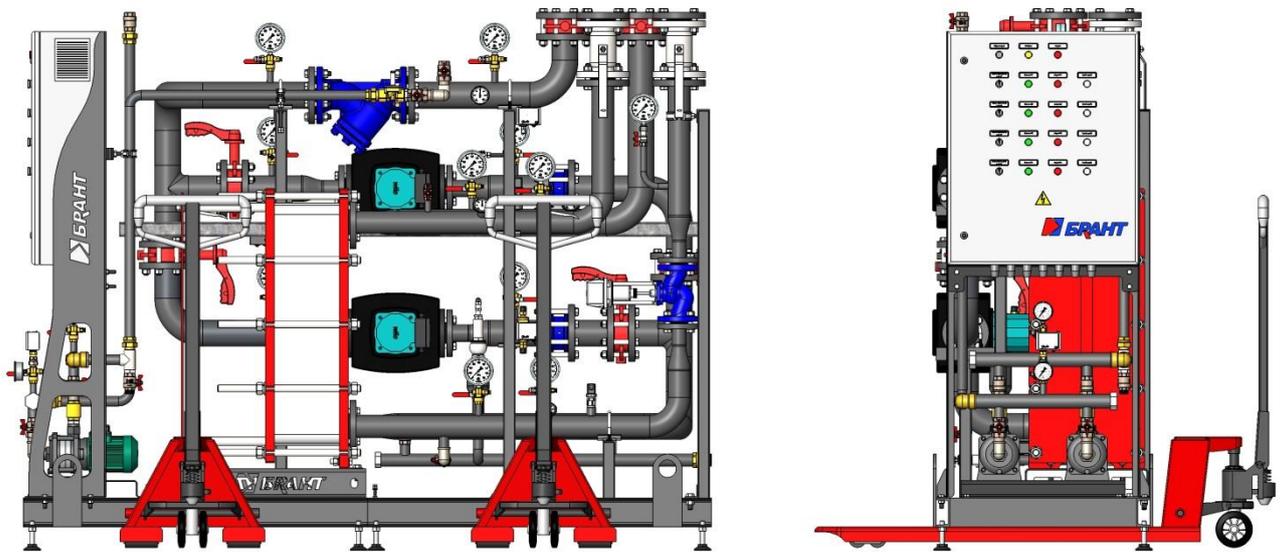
Схема транспортировки блока с помощью вилочной тележки
